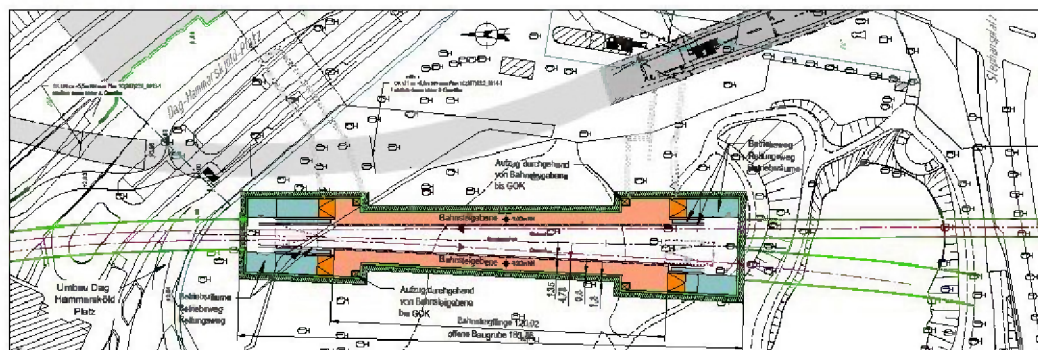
Lageplan Haltestelle Stephansplatz I
